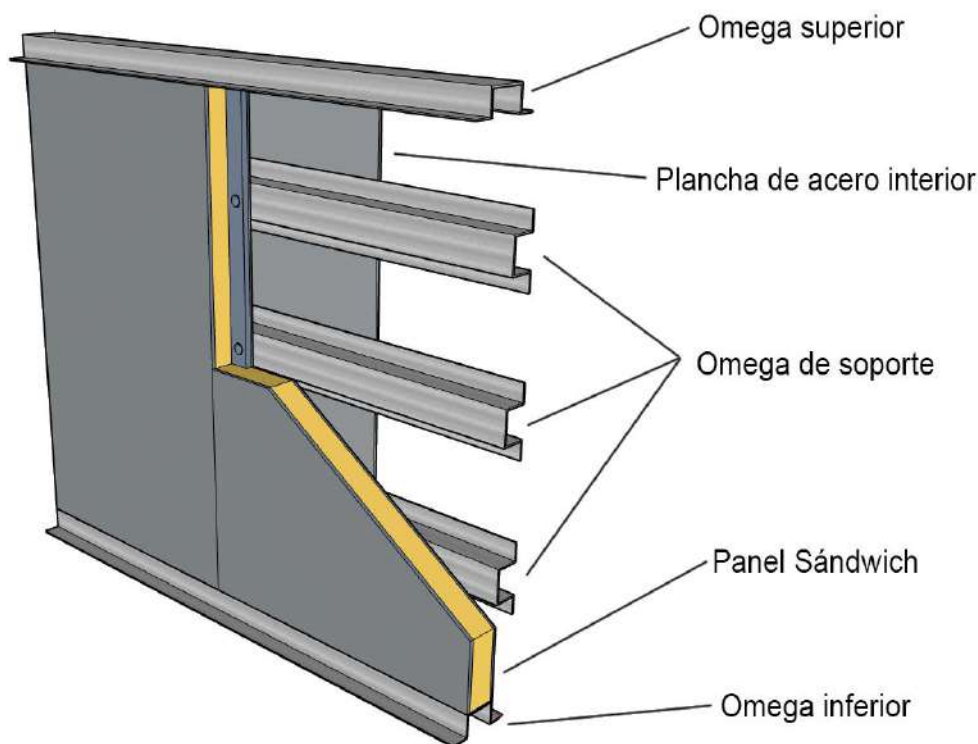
Ensamblaje de las uniones de los paneles en cubierta. Fuente: Grupo Panel Sándwich
